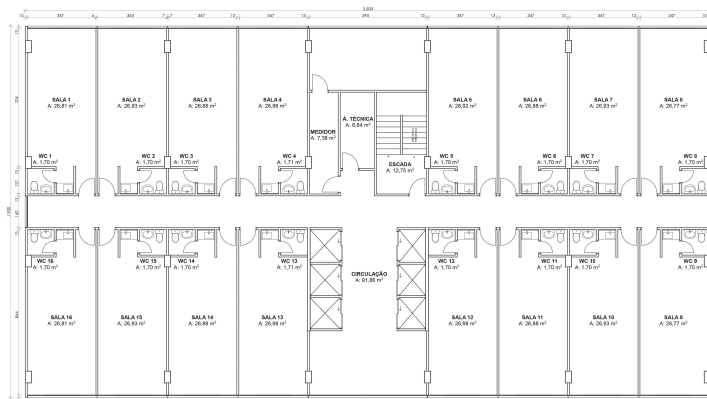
Planta do Pavimento Tipo do edifício modelo.
